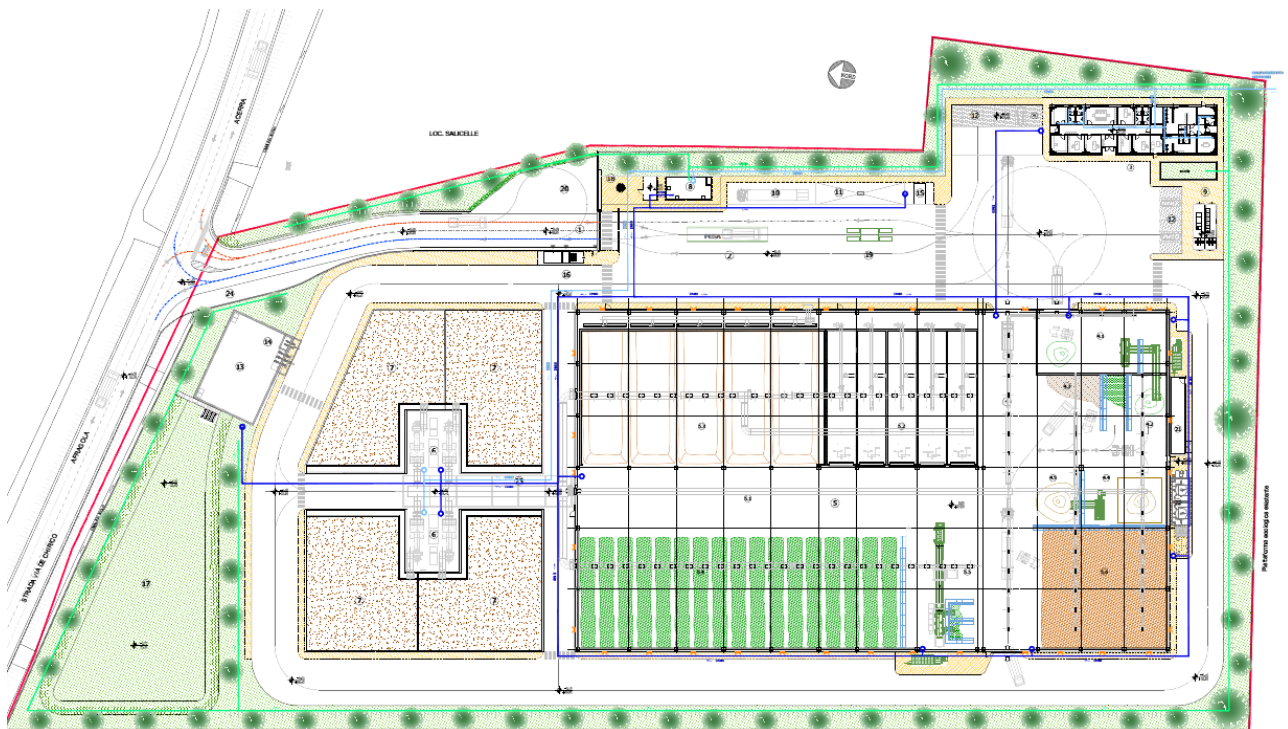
Stralcio planimetria rete idrica (1137-D-I-PL-09-0)
